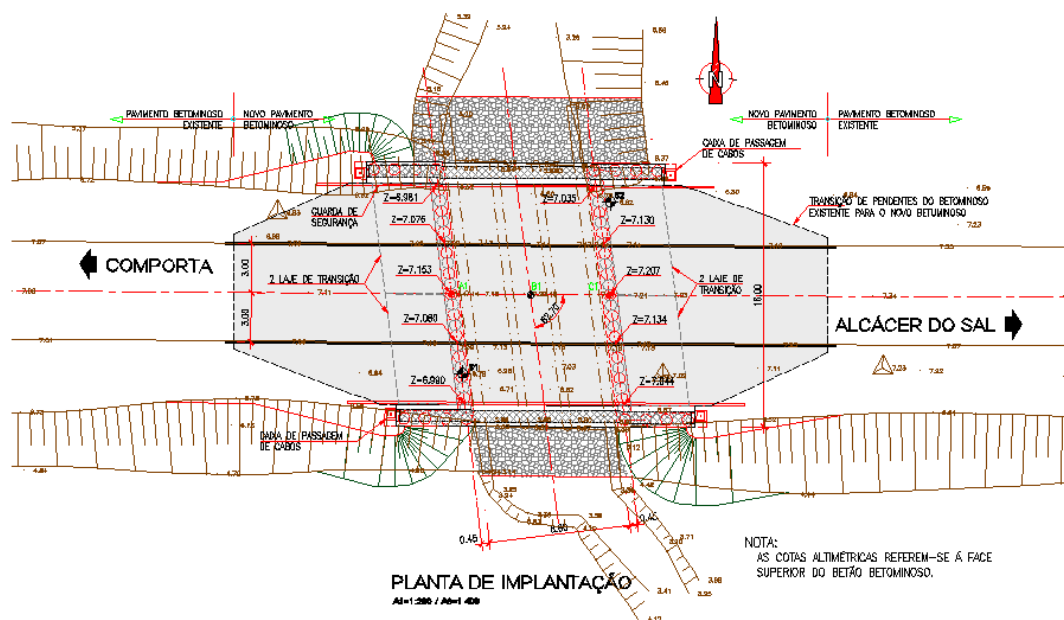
ER 253 - PH ao km 17+332 – Planta
